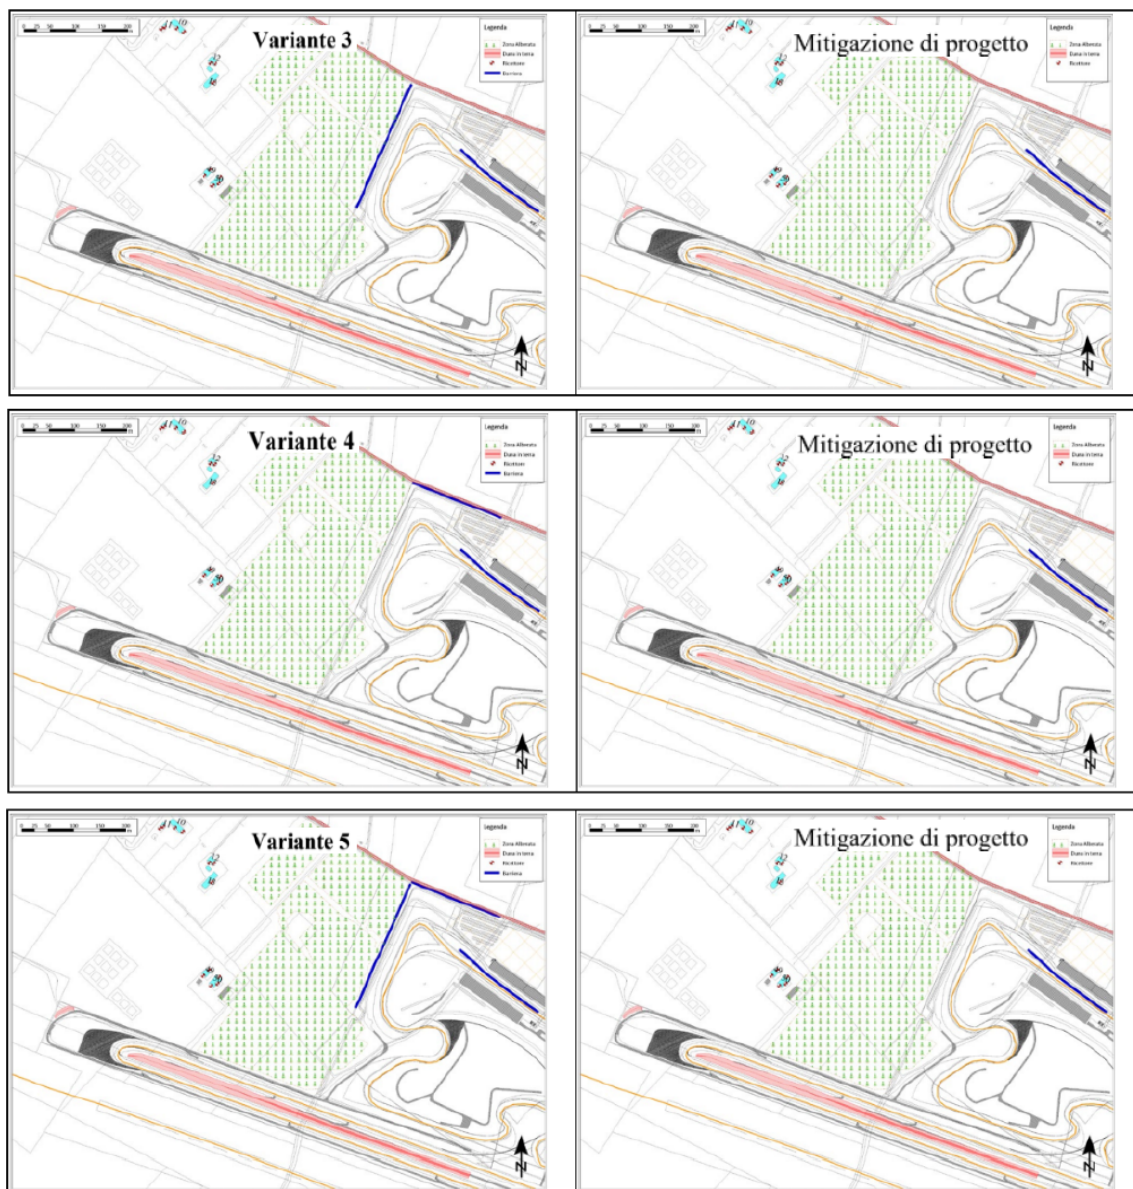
Barriere nelle Varianti 3, 4 e 5 rispetto alle barriere approvate nel PAUR
